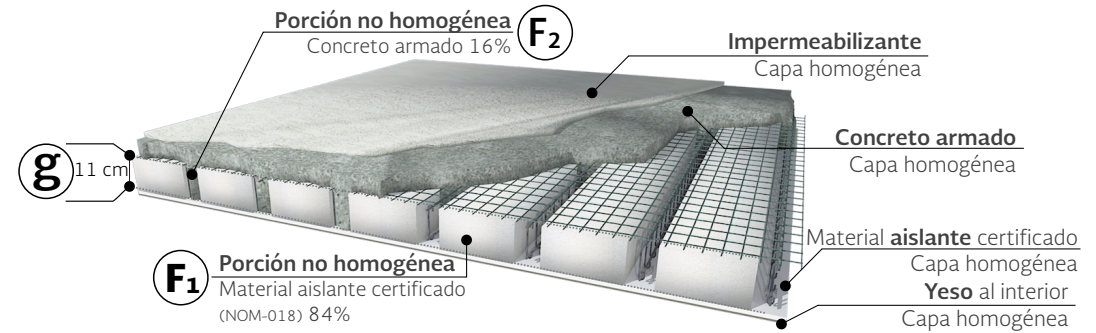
Ejemplo de porción no homogénea. Losa de vigueta de concreto armado y bovedillas de material aislante certificado.
